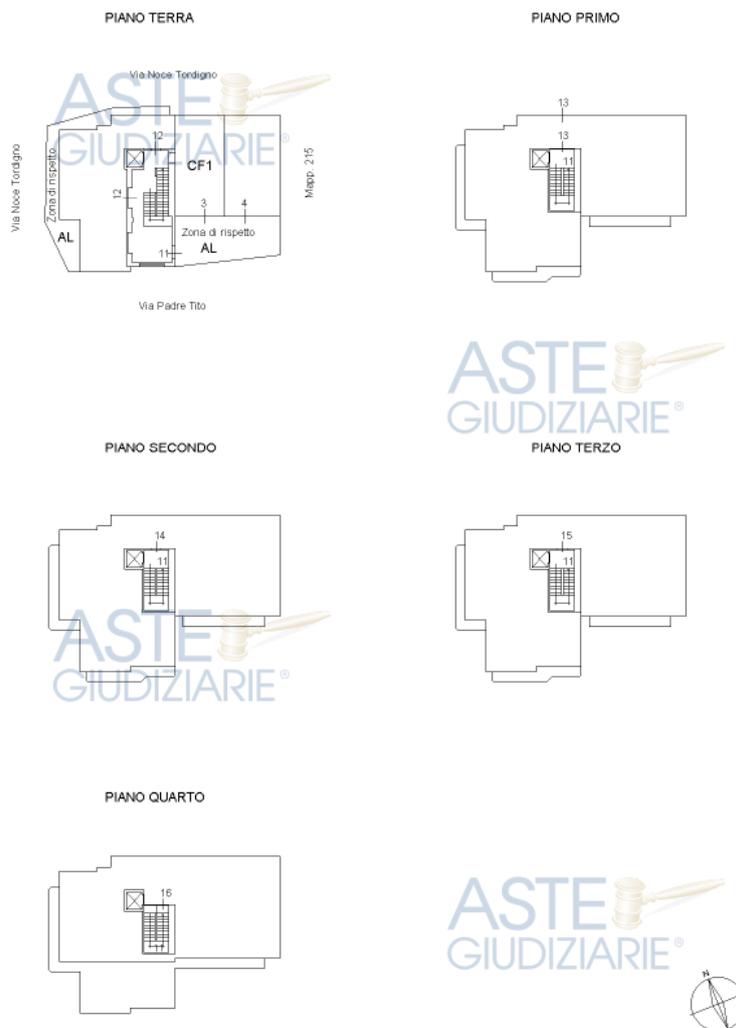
Stralcio Elaborato planimetrico (Allegato 5F)
